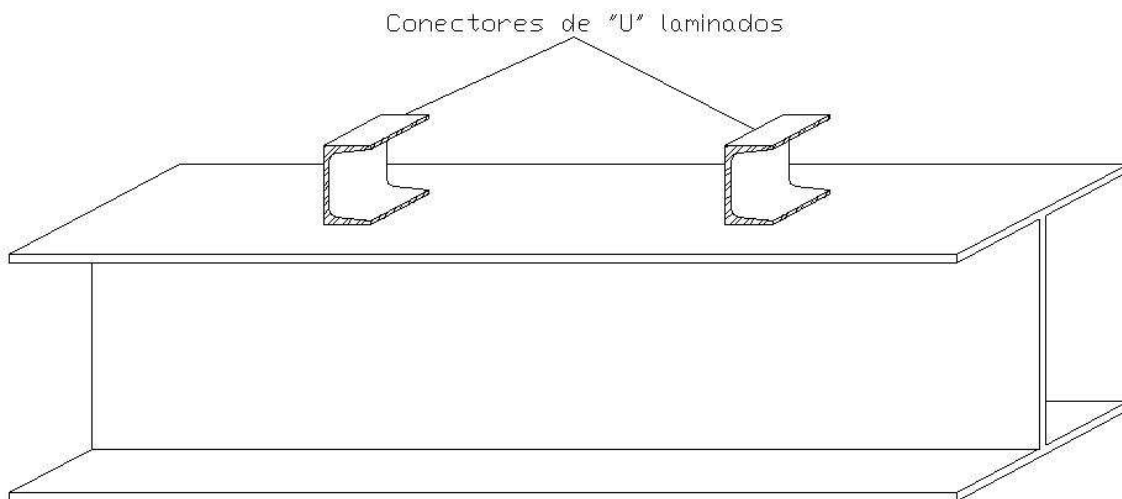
Conectores tipo “U” laminado soldados sobre viga de alma cheia.
